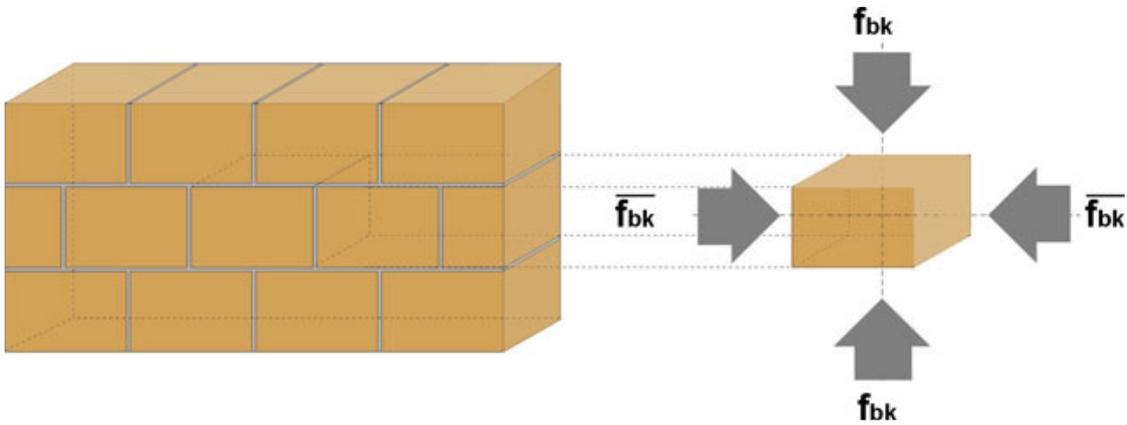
Resistenza a compressione in direzione verticale (f_{bk}) ed in direzione ortogonale al piano di posa nel piano del muro ($\overline{f_{bk}}$) di un blocco in laterizio.
